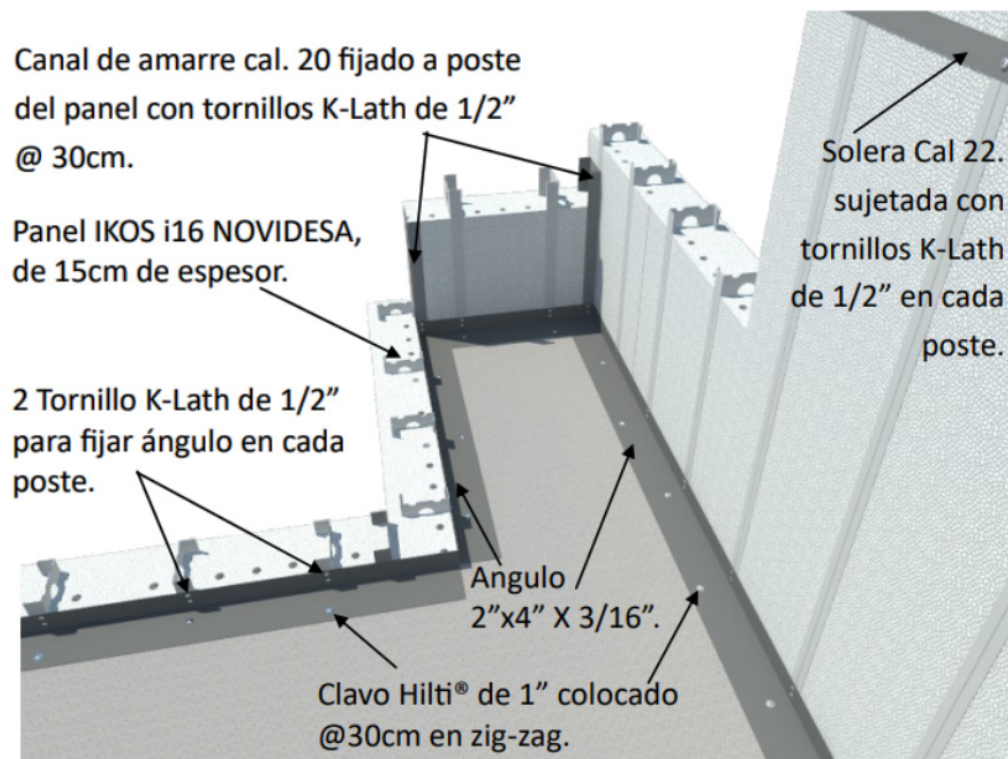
Vista interior de elementos de fachada con paneles de poliestireno. (Elaboración propia).
